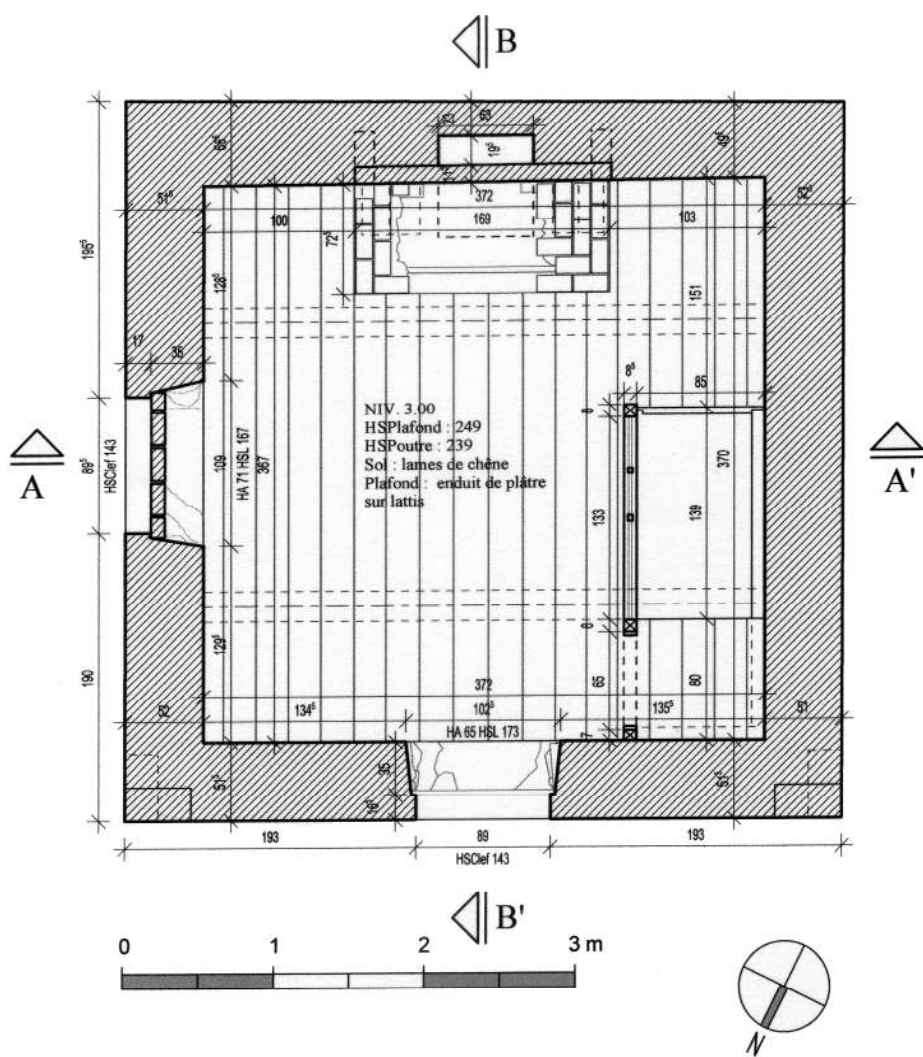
Pavillon. Vue en plan 1^{er} étage. Ech. 1/50^e. Situation existante. IG 2003.
